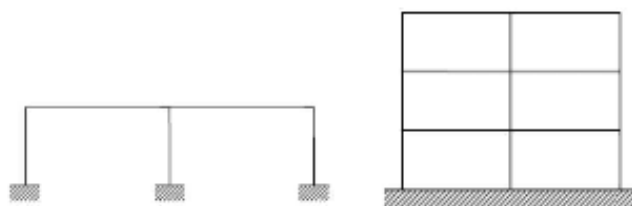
Estruturas em pórticos com ligações monolíticas
